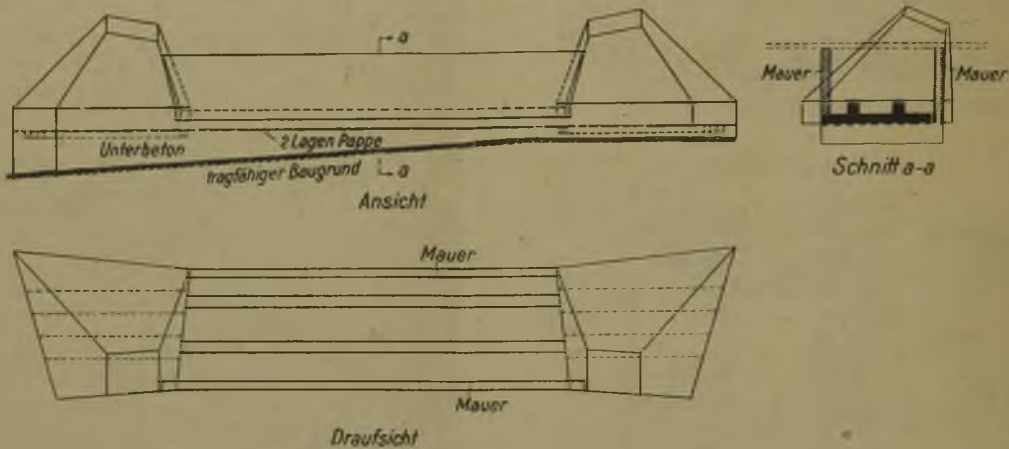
Abstandssicherung der Strebenfundamente eines Fördergerüsts.
